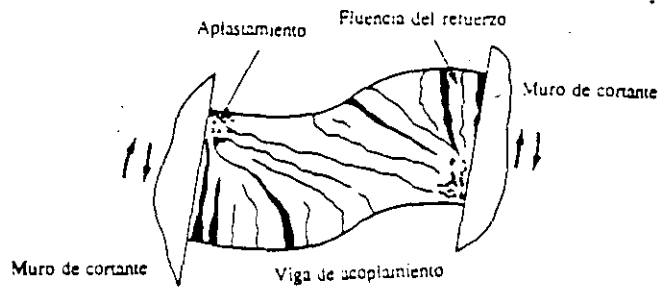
Deformación y agrietamiento de vigas de acoplamiento
